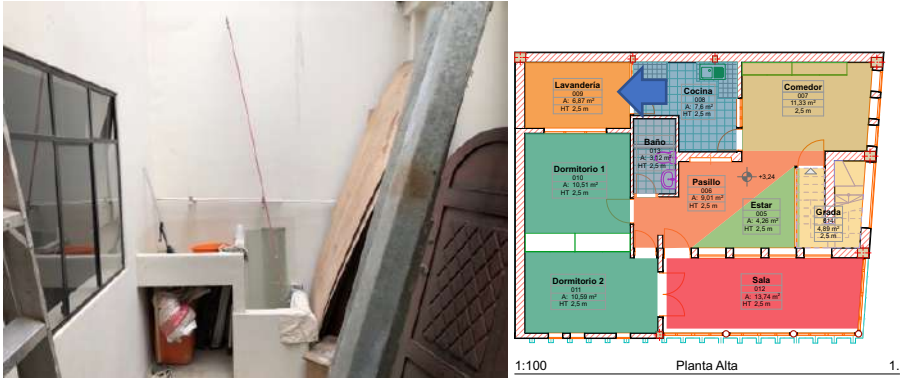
Vista de lavandería en Vivienda Seminario / Autor, 2023
